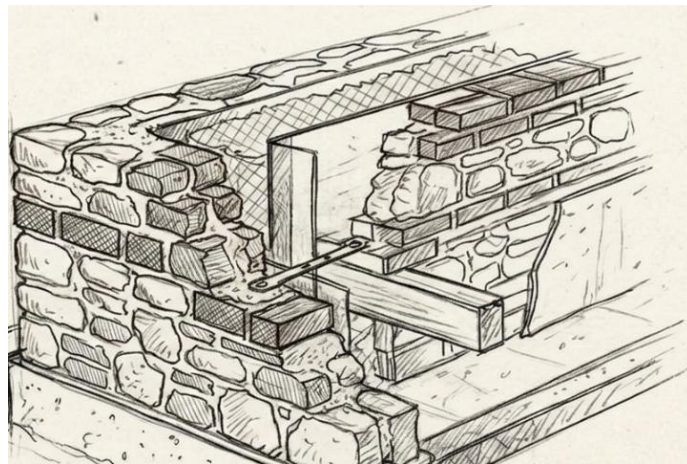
Présentation des murs porteurs en maçonnerie de pierres.
